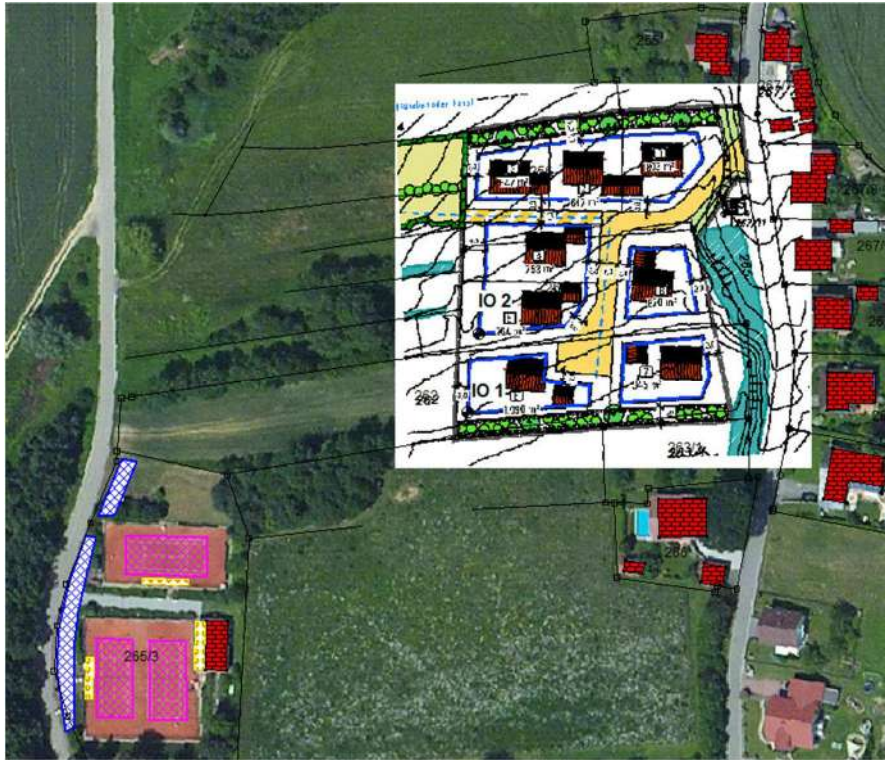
Lageplan mit Kennzeichnung Immissionsorte IO1 – IO2
